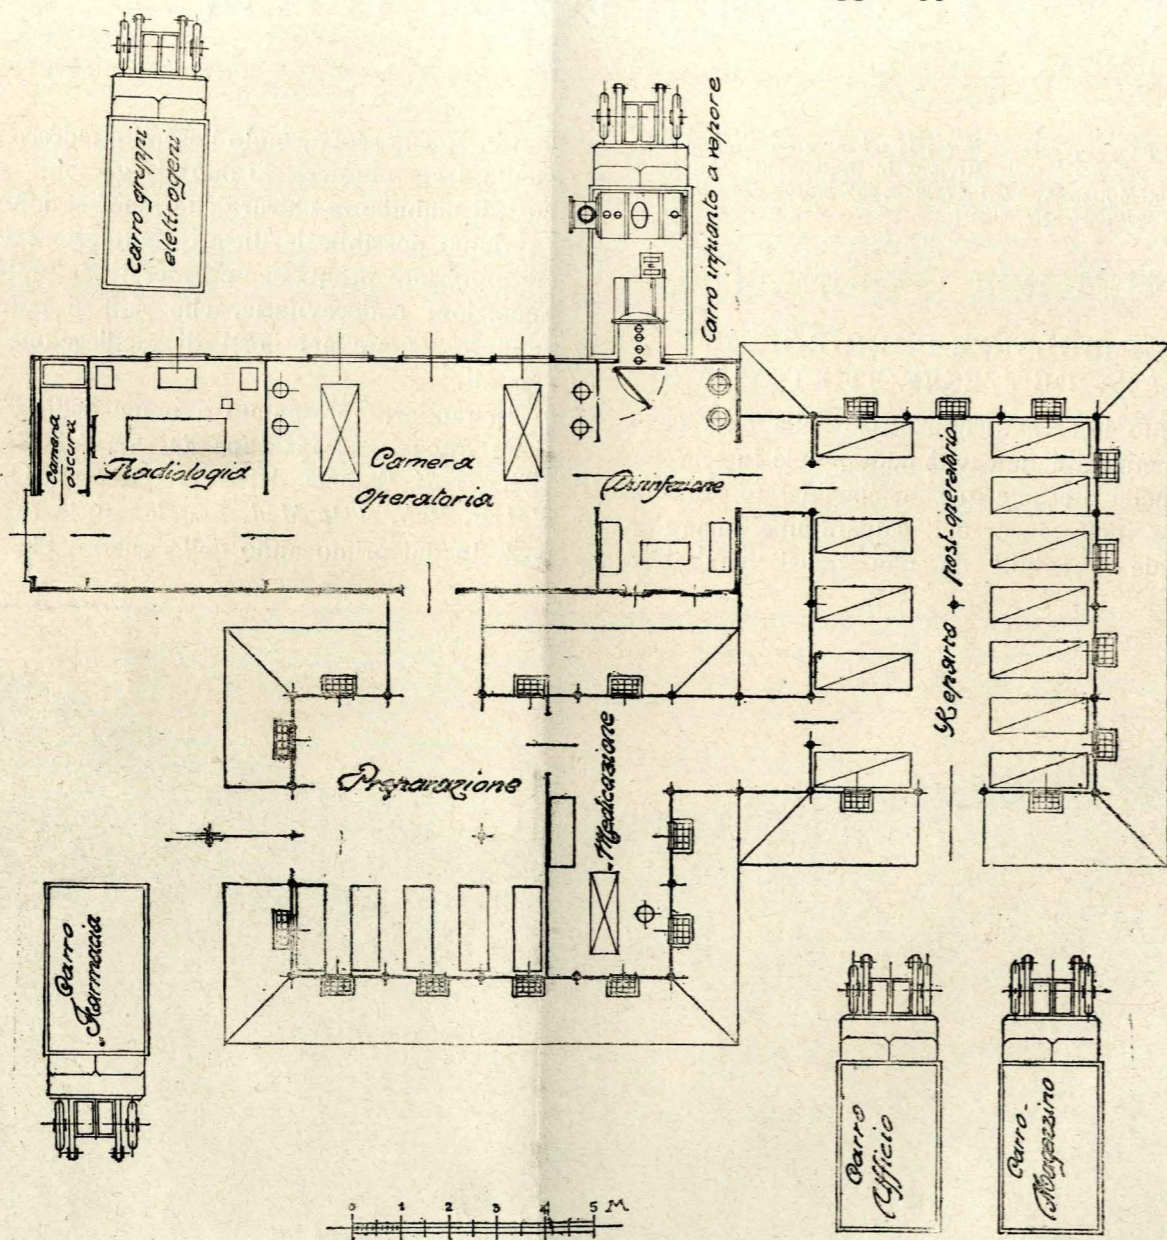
Disposizione planimetrica generale delle Ambulanze in funzione.
